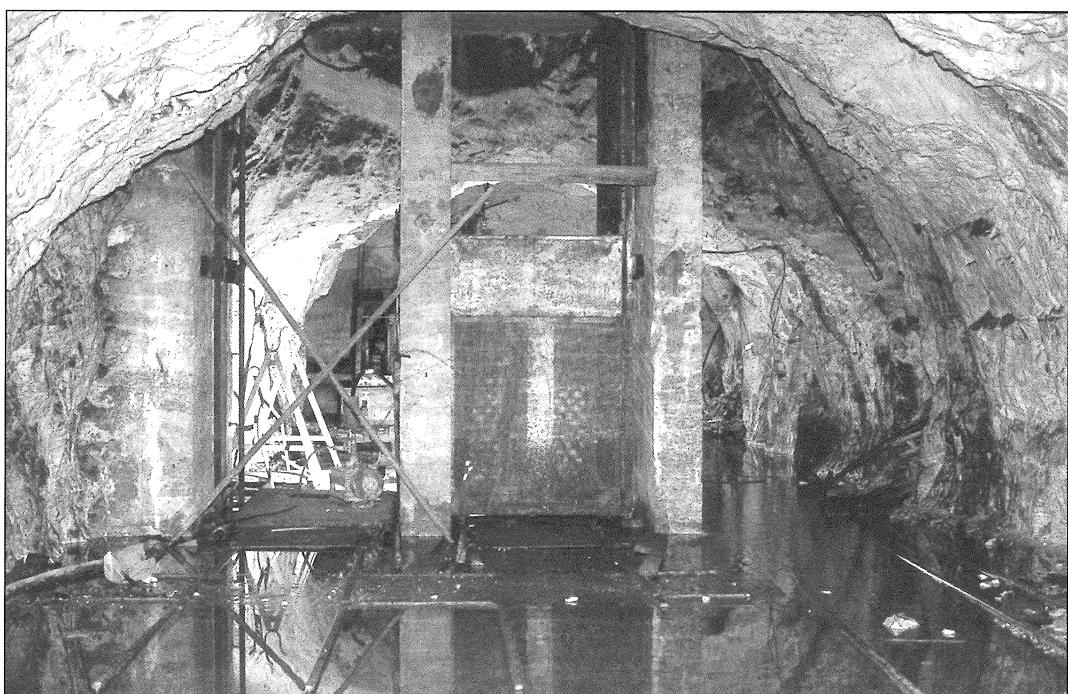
Situation am Krummörter-Schacht (Bergbau Falkenstein), Foto Hanneberg.
